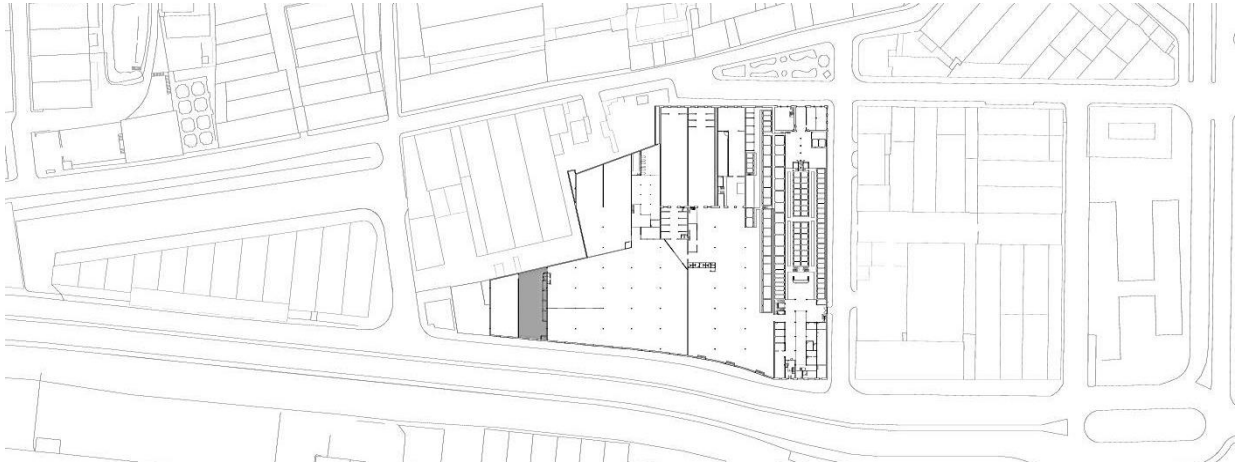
Planta de levantamento fotográfico piso térreo – Armazéns 20.
